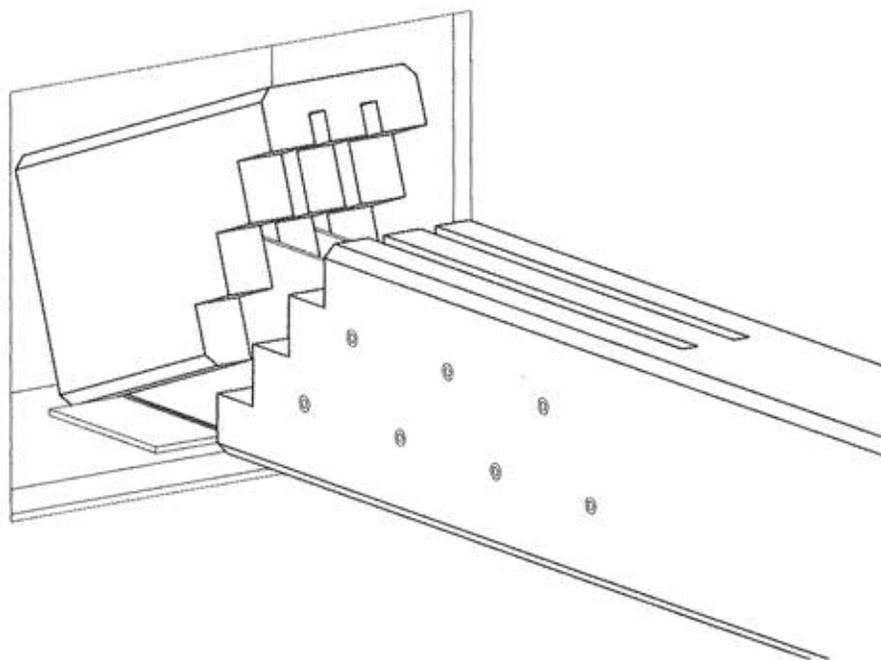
d – Ricostruzione dell'appoggio della trave con protesi costituita da profilati piatti d'acciaio. Fase 4: posa in opera della protesi di legno.
